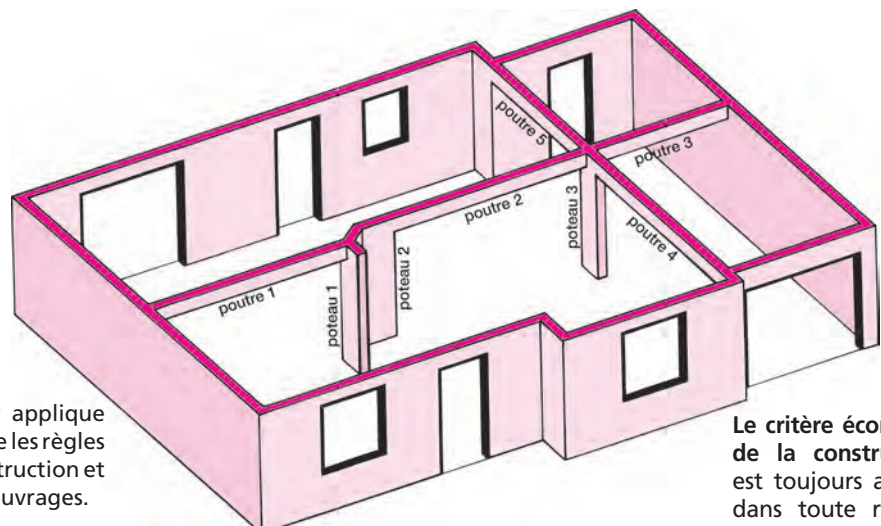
Schéma de la structure porteuse du plancher haut du rez-de-chaussée
